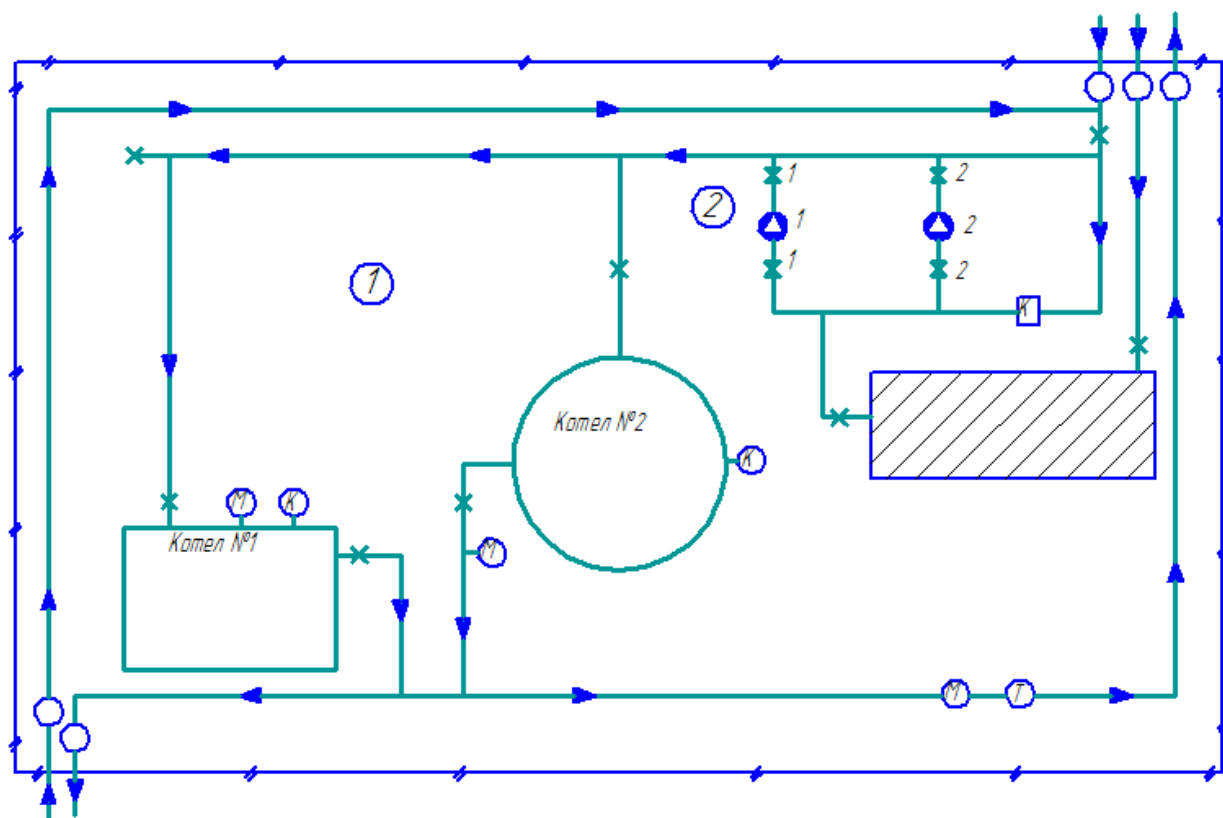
Тепловая схема котельной № 6: 1 – котельное помещение; 2 – склад топлива; 3 – насосная
